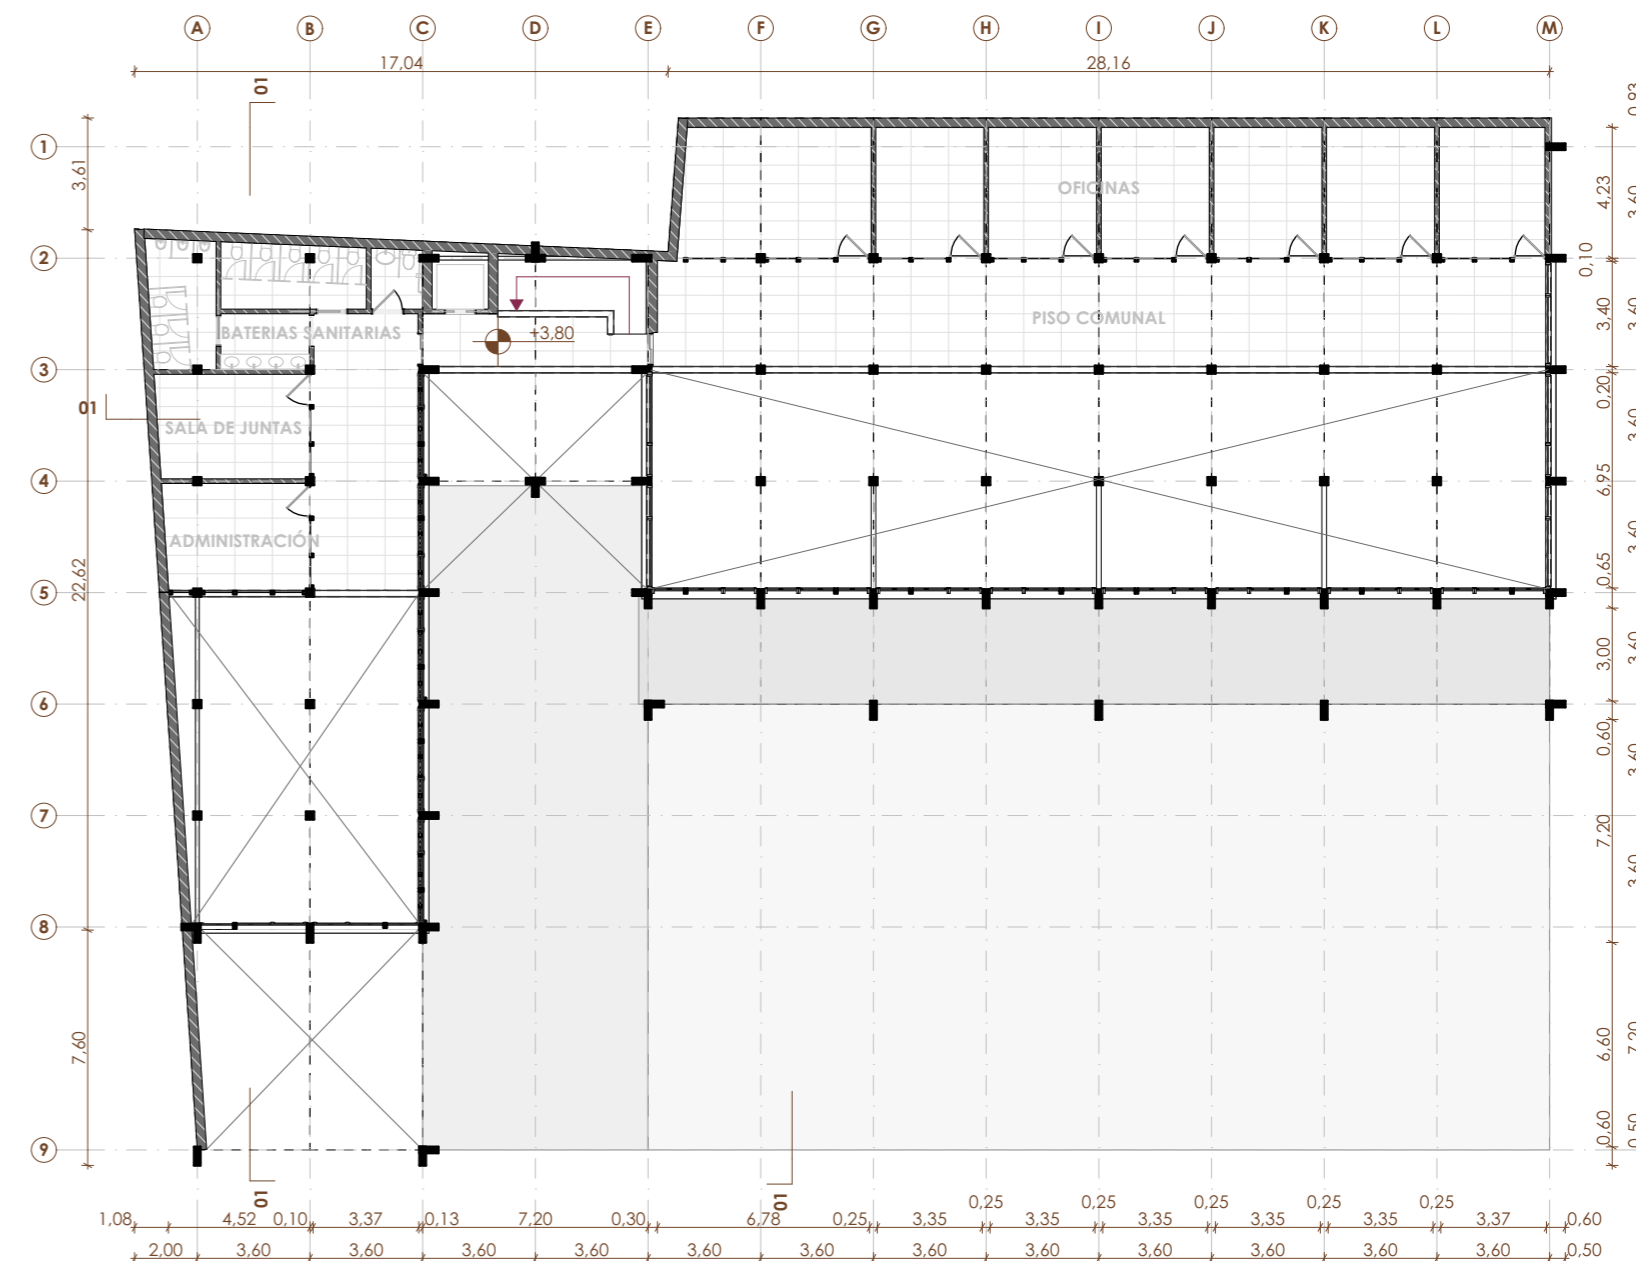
Primera planta alta Mercado Sacay. Fuente: Autoría propia (2026).
